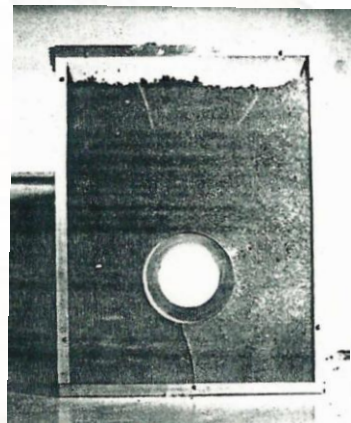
Estágio de construção após a remoção do escoramento interno.
